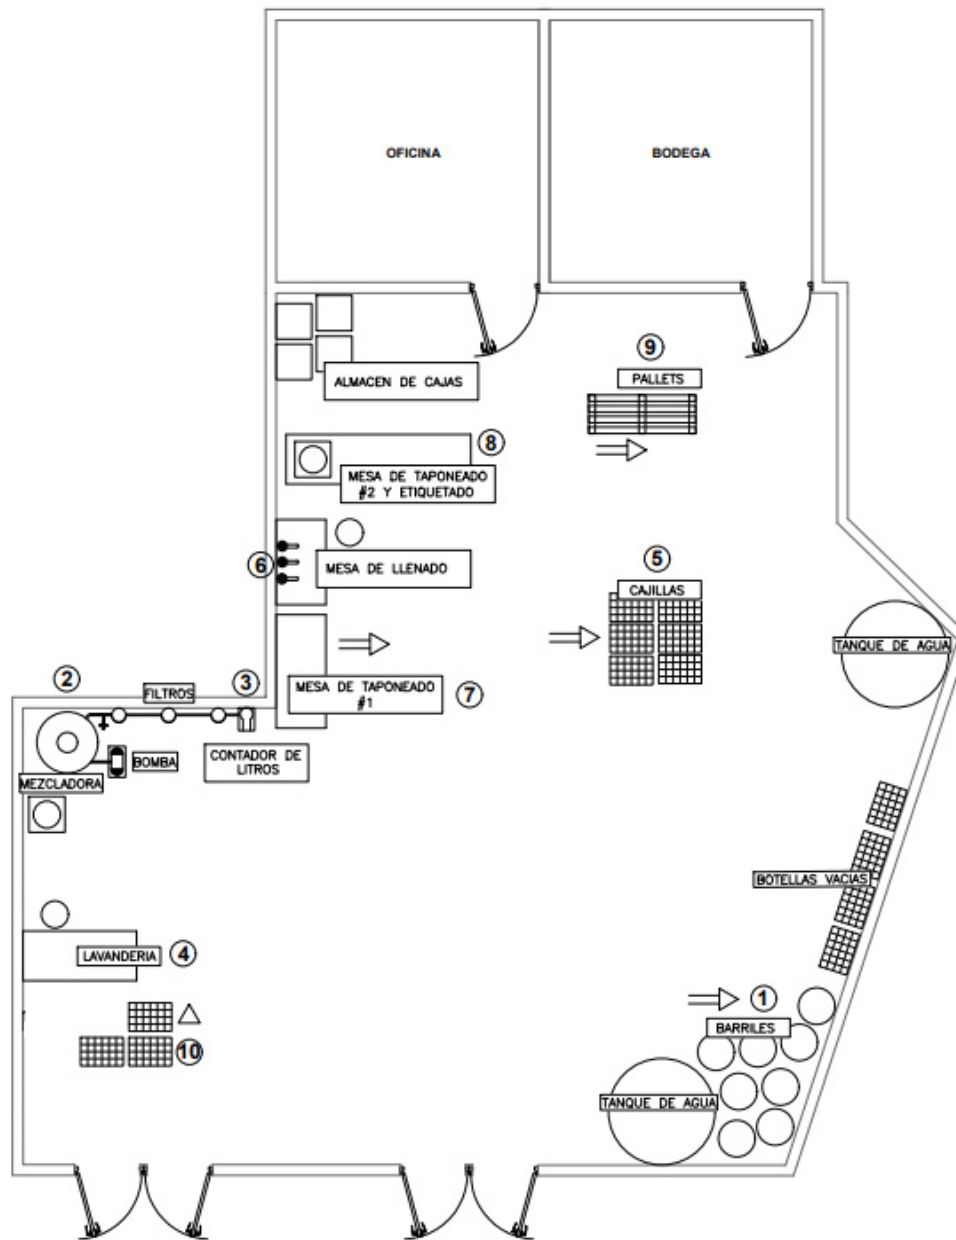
Representación de planta actual. Silva 2018. No publicada.
